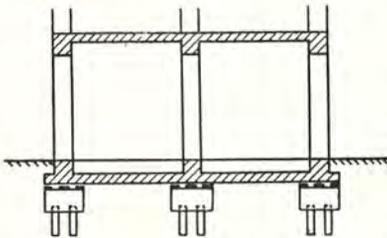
Séparation de la fondation sur pilotis et de la base du bâtiment par un joint de glissement.
